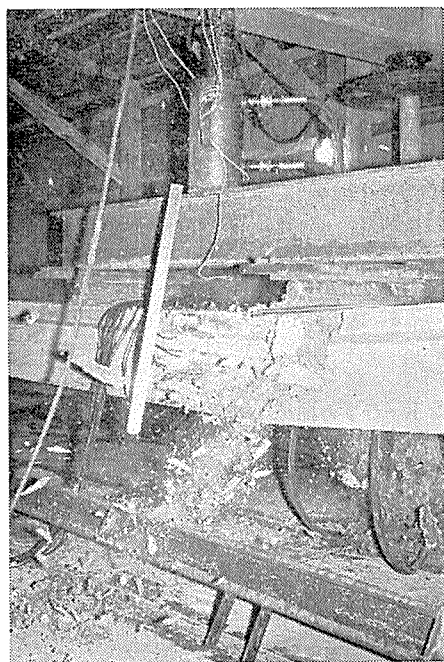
(a) 試験桁ひびわれ発生および破壊状況
